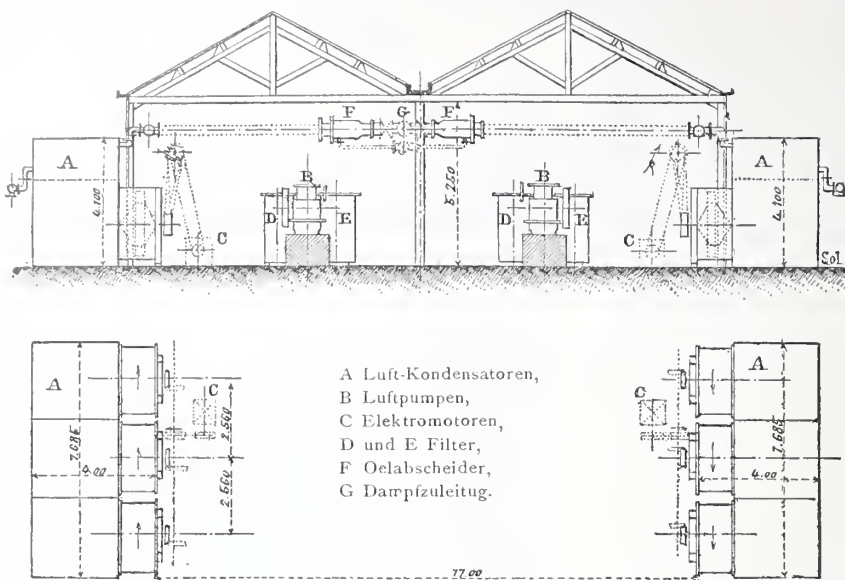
Grundriss und Schnitt. — Masstab 1:250.
